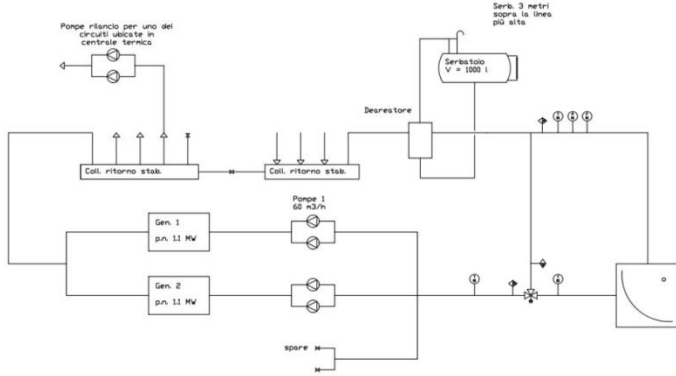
Schema semplificato della modalità di connessione dell'impianto solare all'impianto esistente
